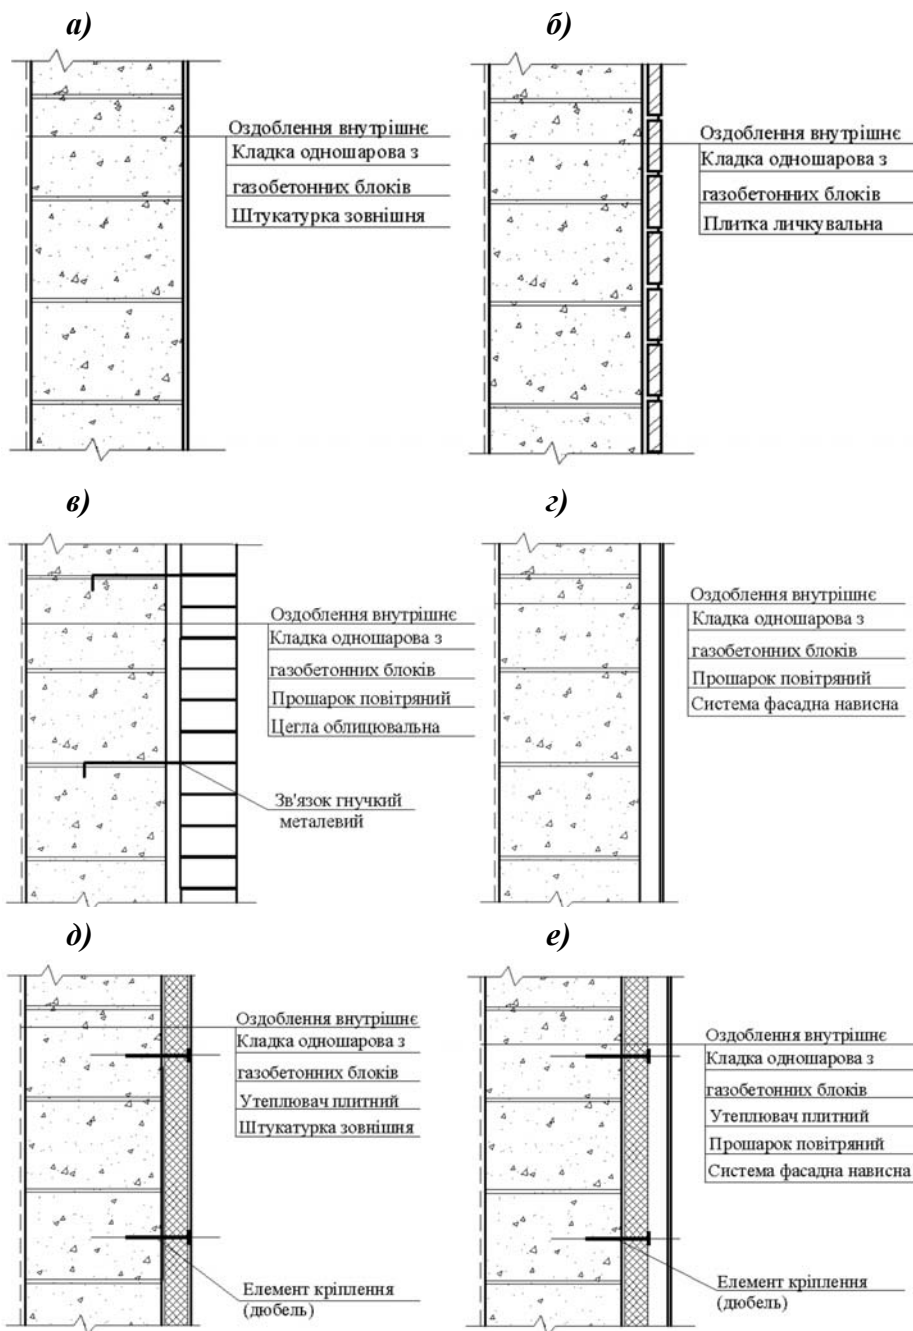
Конструкції многослойных наружных стен из газобетонных блоков с дополнительными теплоизоляционными и отделочными слоями:
